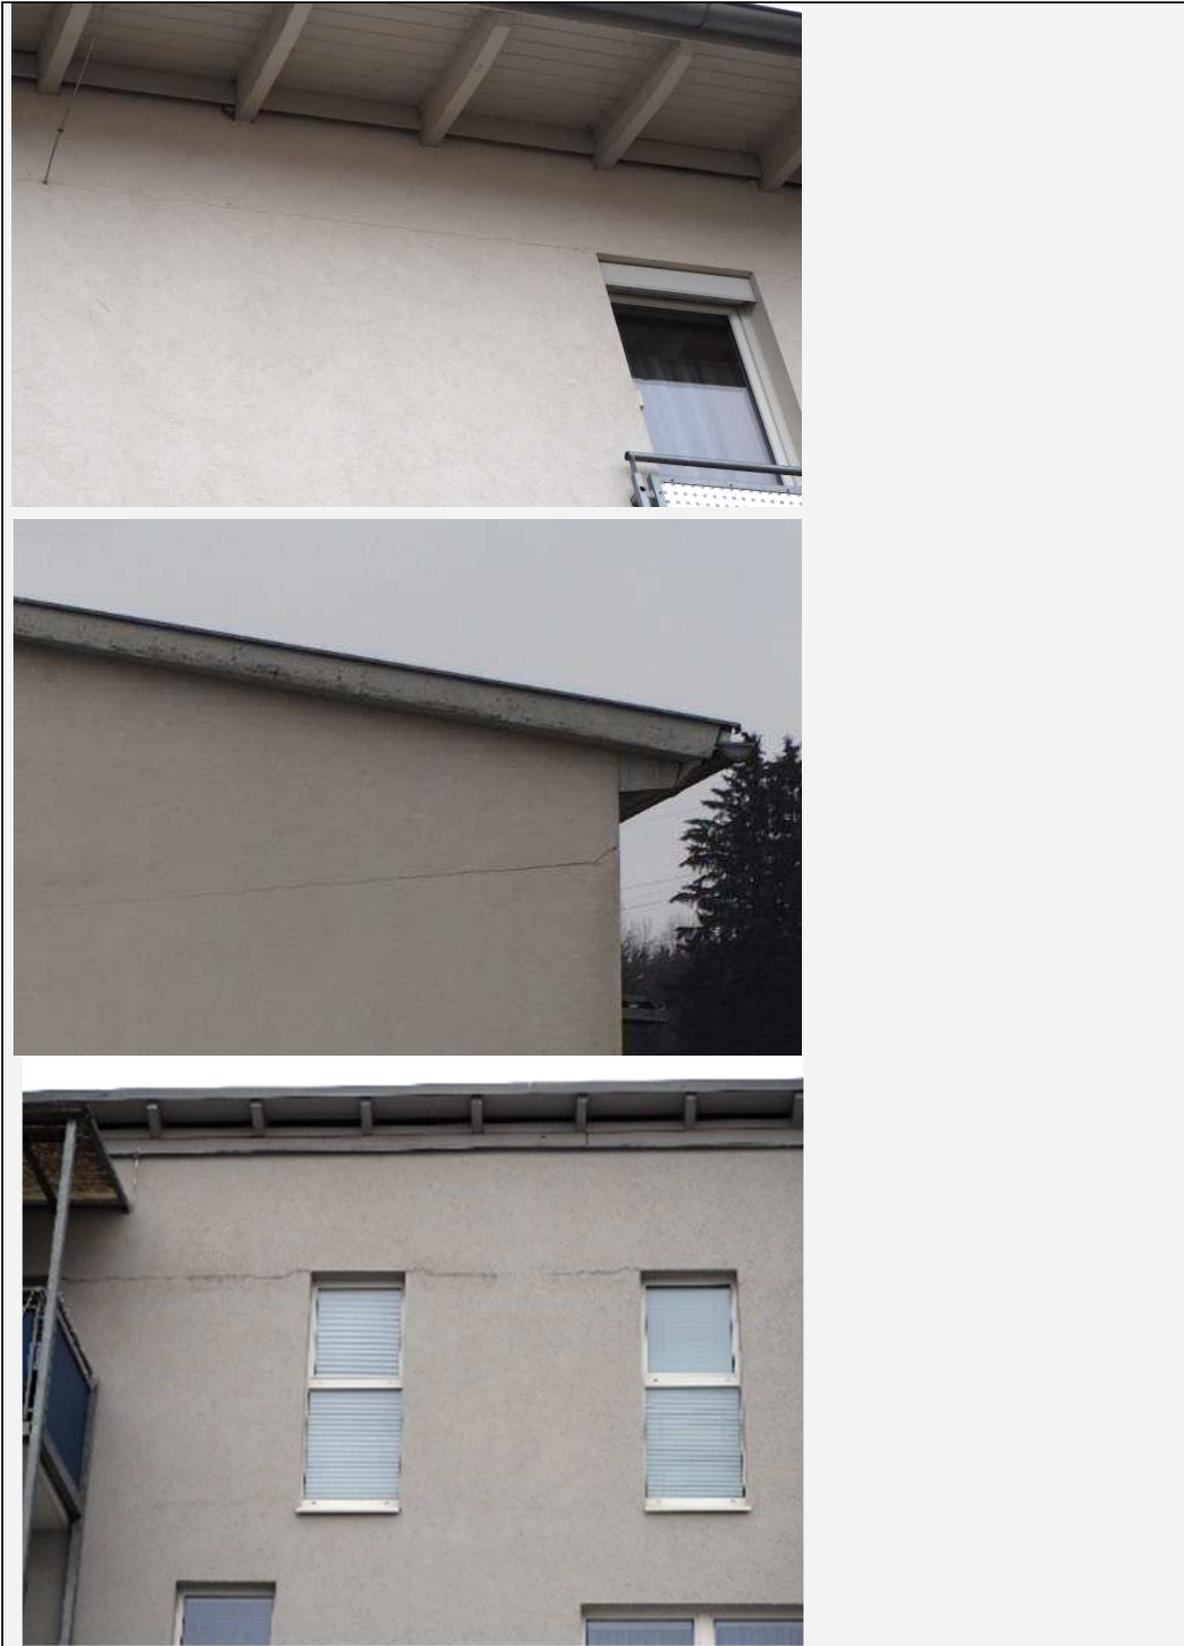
Risse Monolithisches Mauerwerk
